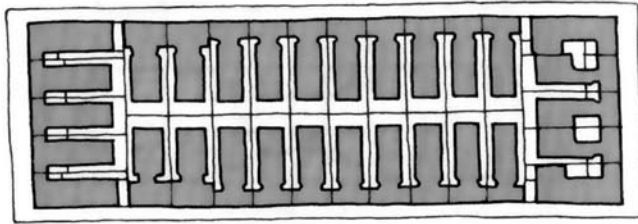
Esquema de aplicación de la New Law de 1901 en la manzana original. Fuente: Madariaga, Inés Sánchez de. Madrid (1999).
